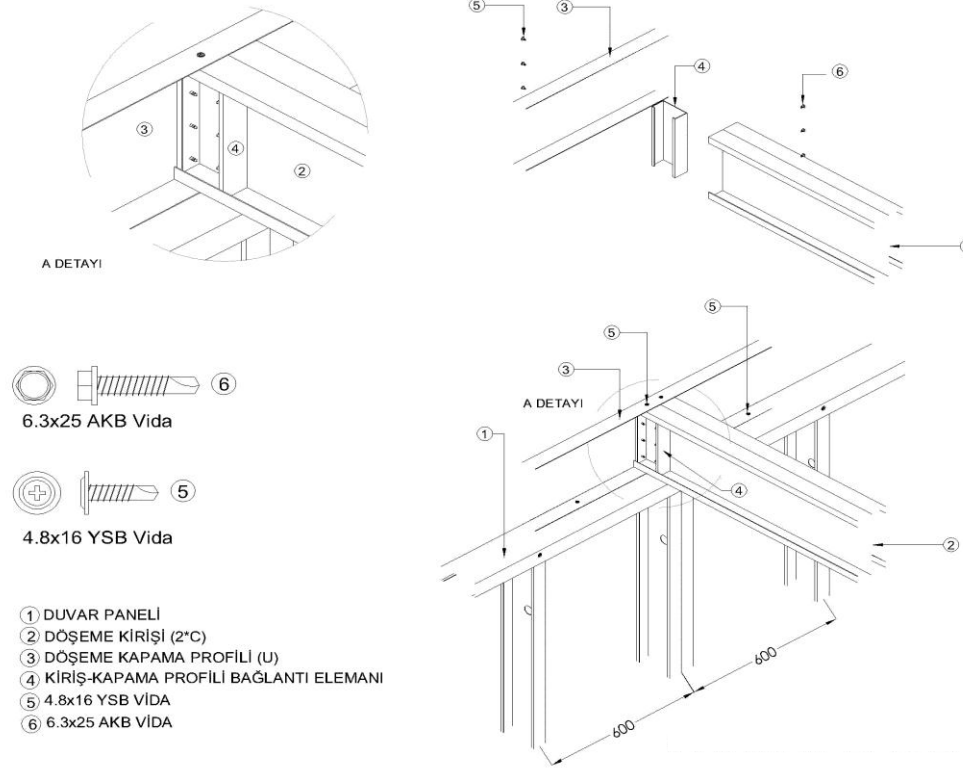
Arakat panel-kiriş-döşeme bağlantı detayı
